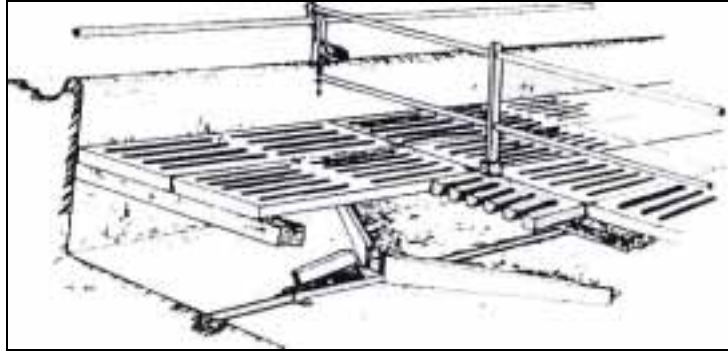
Raschiatore meccanico installato al di sotto del pavimento fessurato
